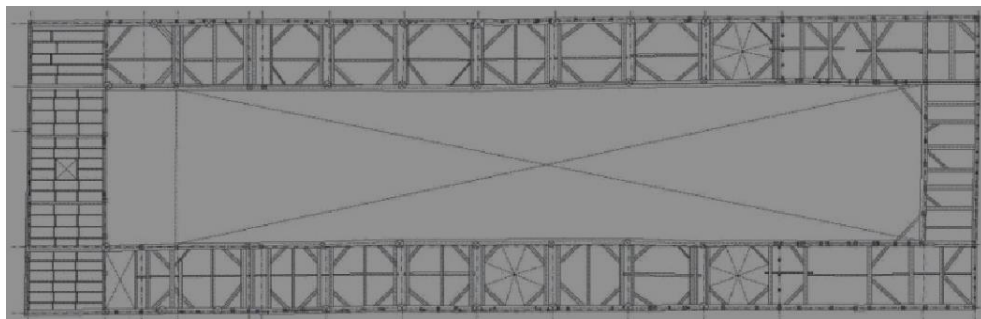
Iglesia de Achao, sección estructura cubiertas laterales
